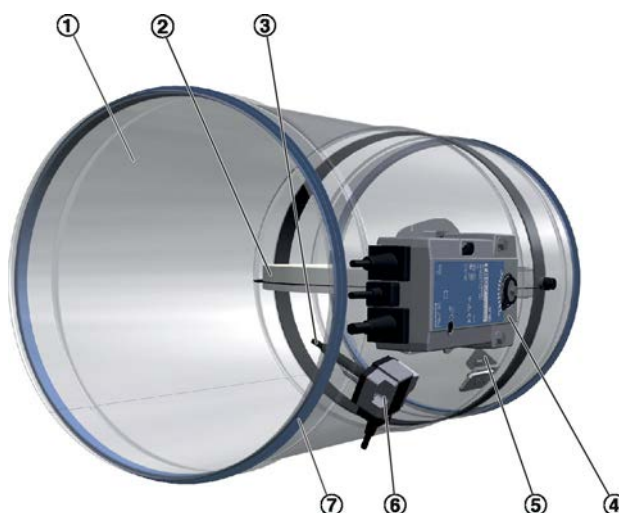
FKR-EU mit Federrücklaufantrieb (Abb. Stutzenausführung)
